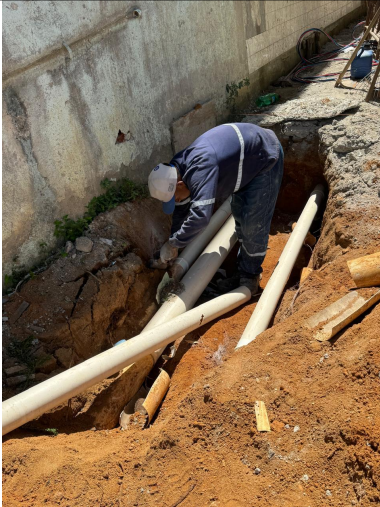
Instalações para drenagem de águas pluviais e manutenção da rede de esgoto
